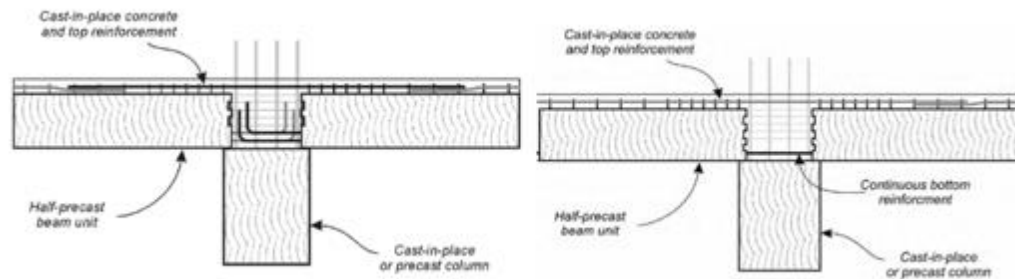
Posibilidades de detallado de refuerzo para la conexión de vigas entre columnas (Blandón & Rave, 2016).
